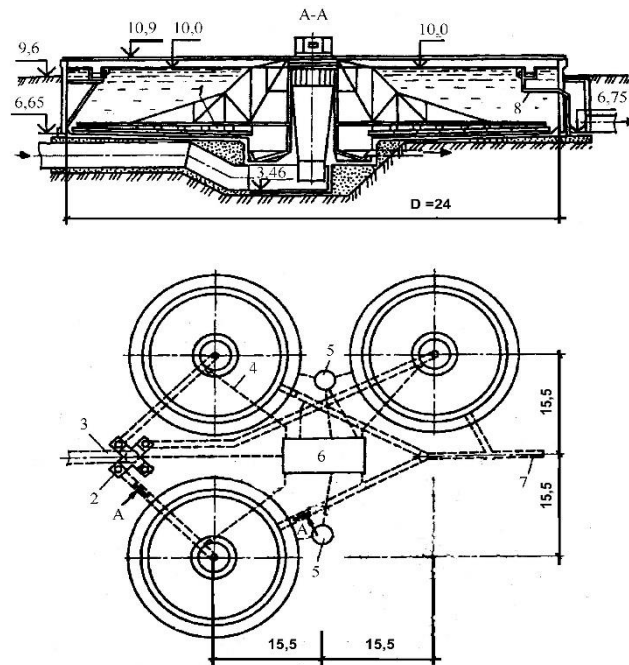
Первичные радиальные отстойники: 1 - илоскреб; 2 – распределительная камера; 3 – подводящий трубопровод; 4 – трубопровод выгрузки осадка; 5 – жиросборник; 6 – насосная станция перекачки осадка; 7 – трубопровод отвода осветленной воды; 8 – жиропровод.
